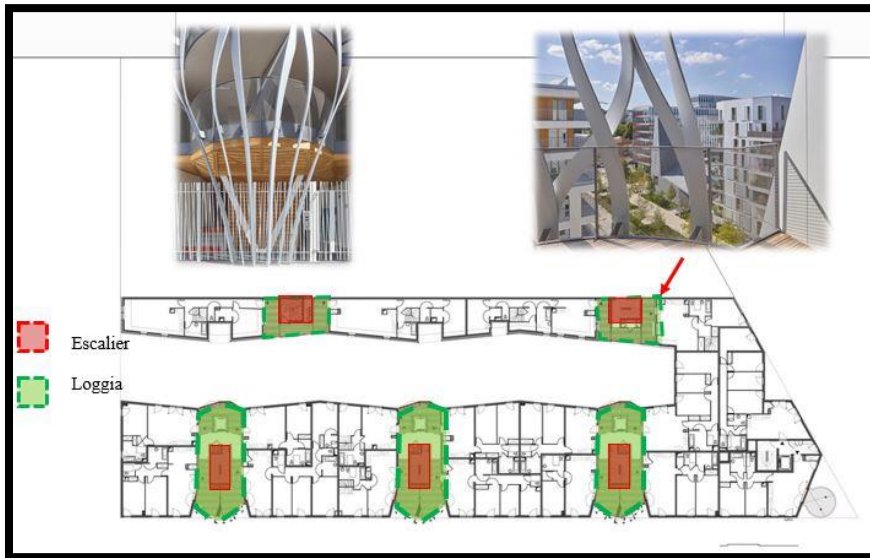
plan schématisant la circulation/ Source : <https://www.archilovers.com>, Traiter par l'auteur.
